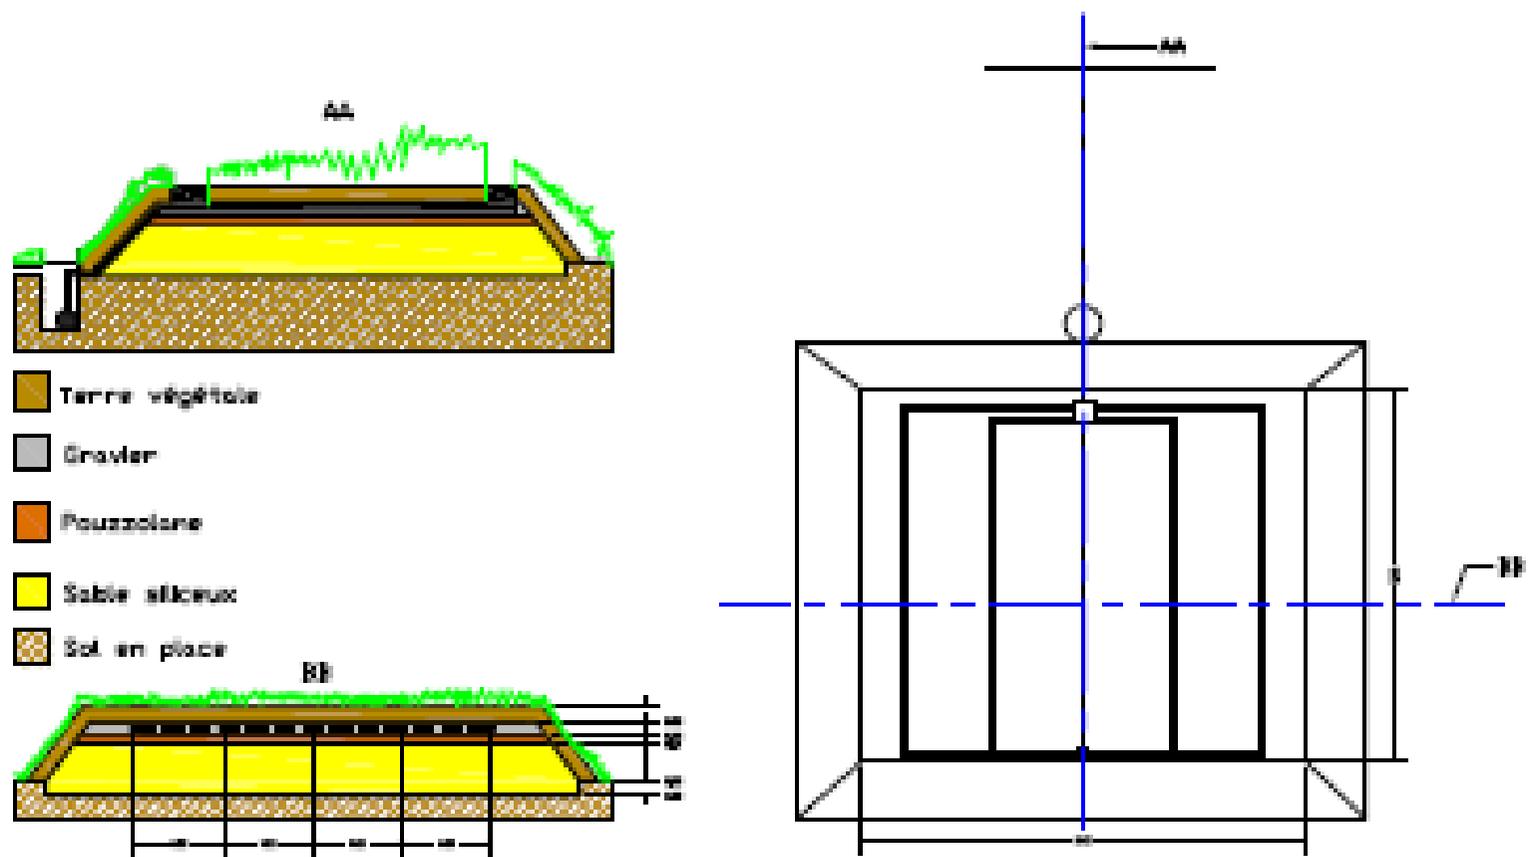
Vue en coupe d'un tertre d'infiltration et des eaux usées
